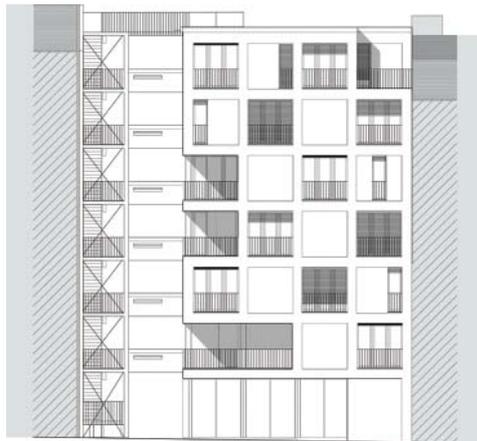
Baulückenbebauung – Baugemeinschaft e3 in Berlin
